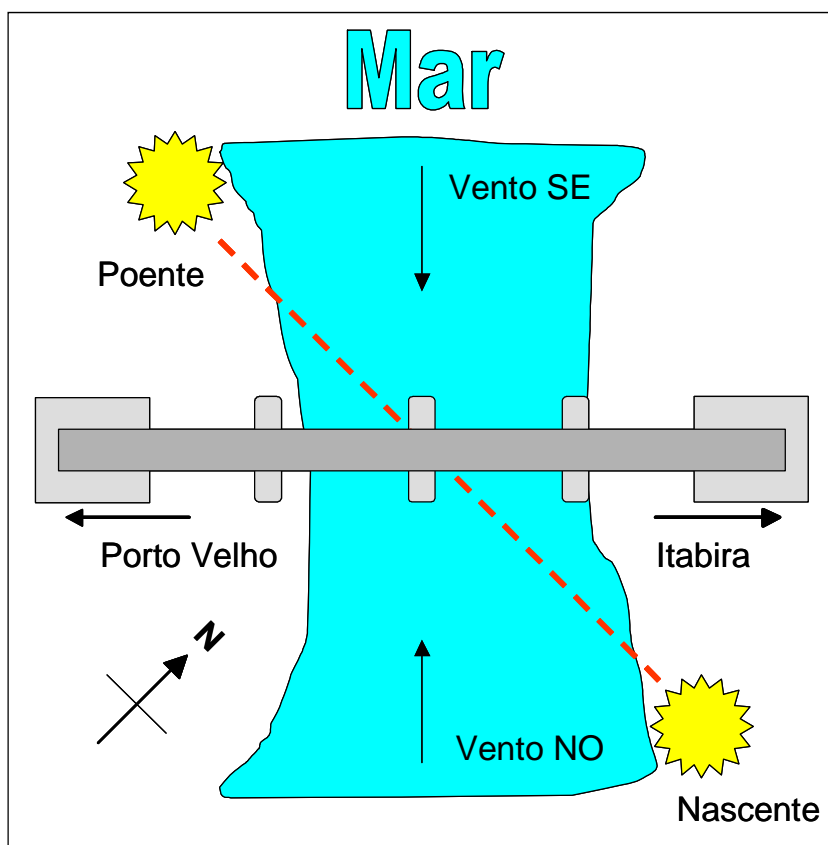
Croqui de implantação da ponte sobre o rio Bubú.
